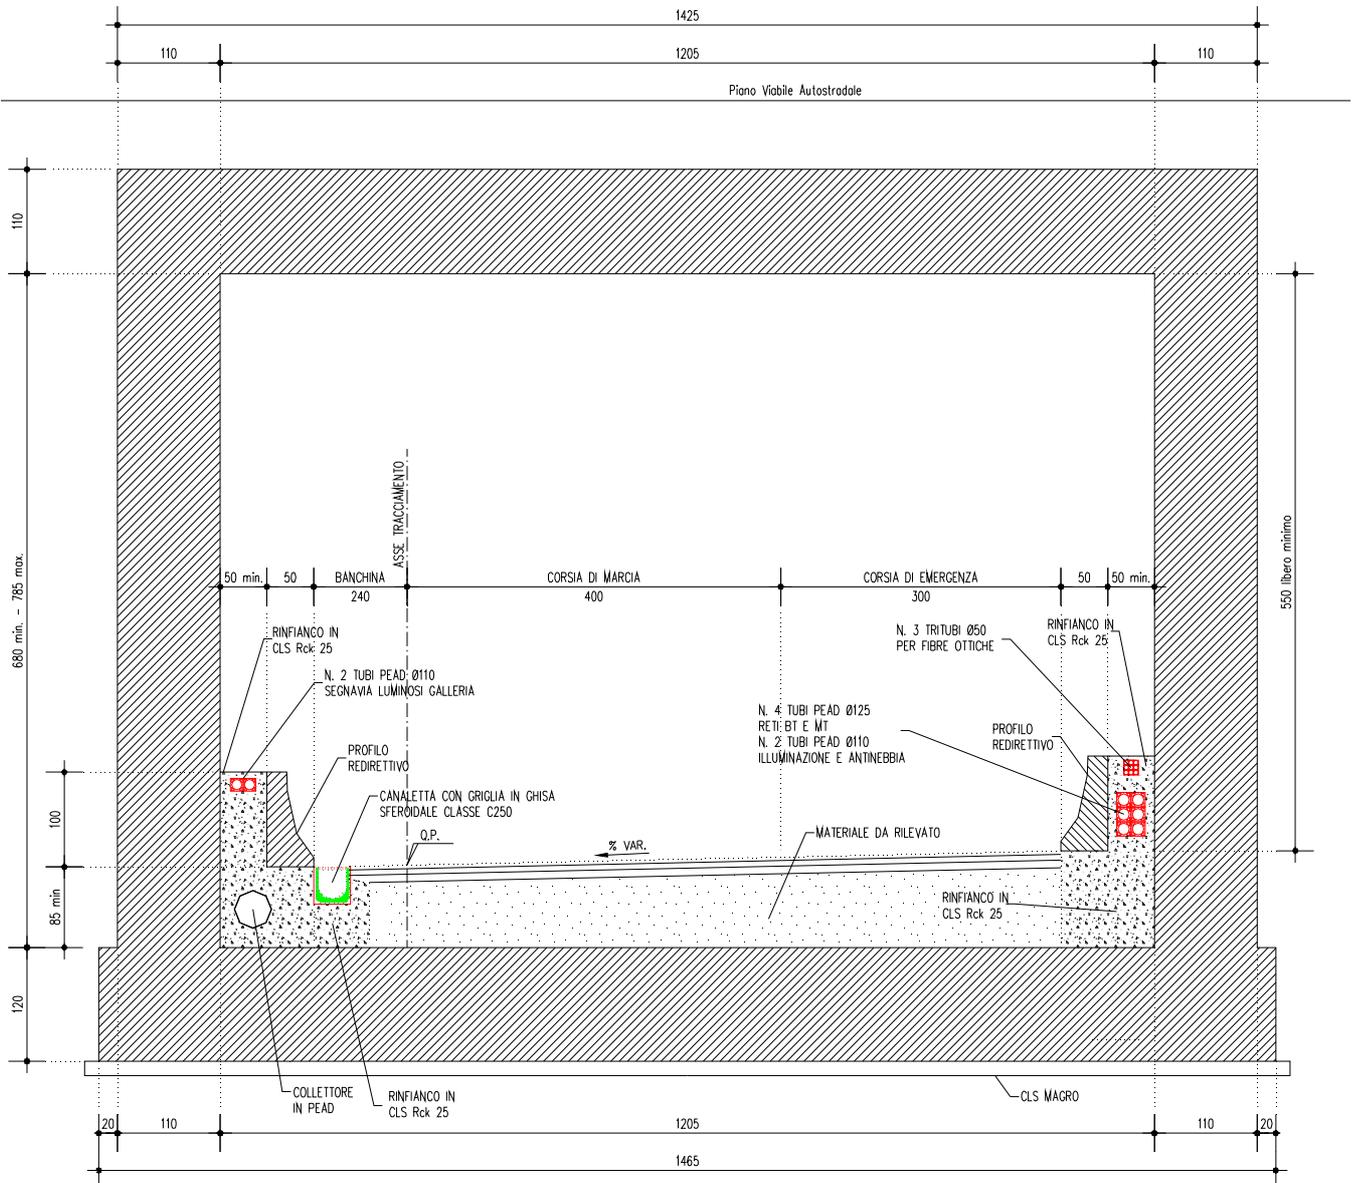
SEZIONE TRASVERSALE SOTTOVIA SCATOLARE
